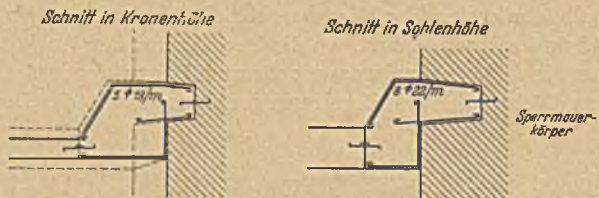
Einbinden des Betonkerns in die Sperrmauer; Bewehrung des Anschlusses.
